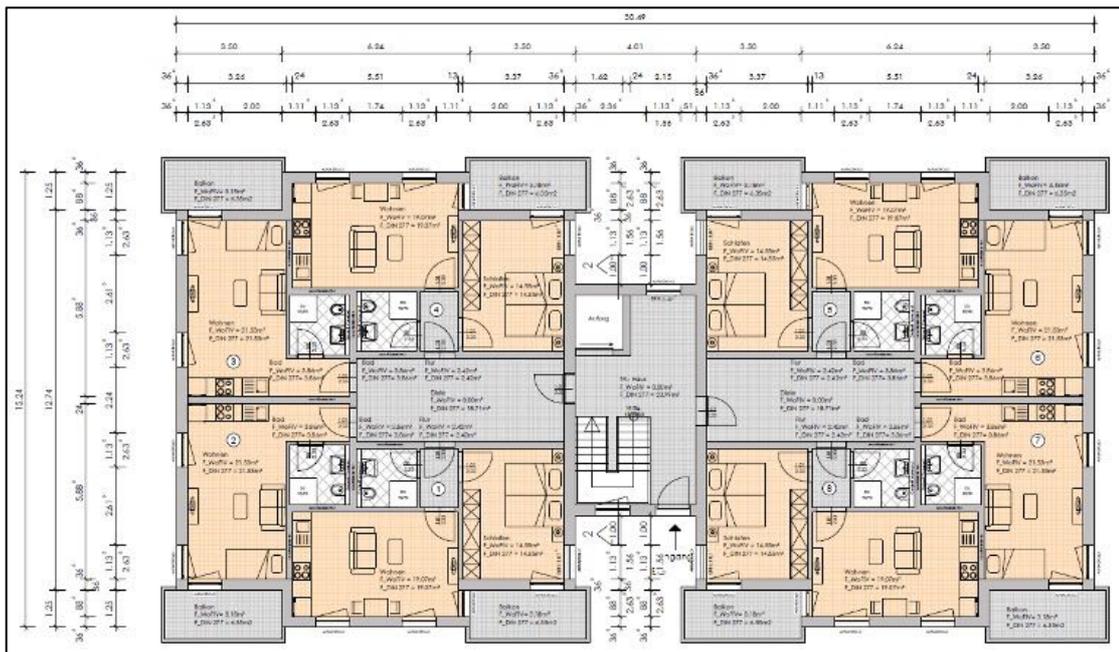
Gebäudegrundriss (Abbildung: Bartelmeß Architekten & Ingenieure , Rauschenberg)
